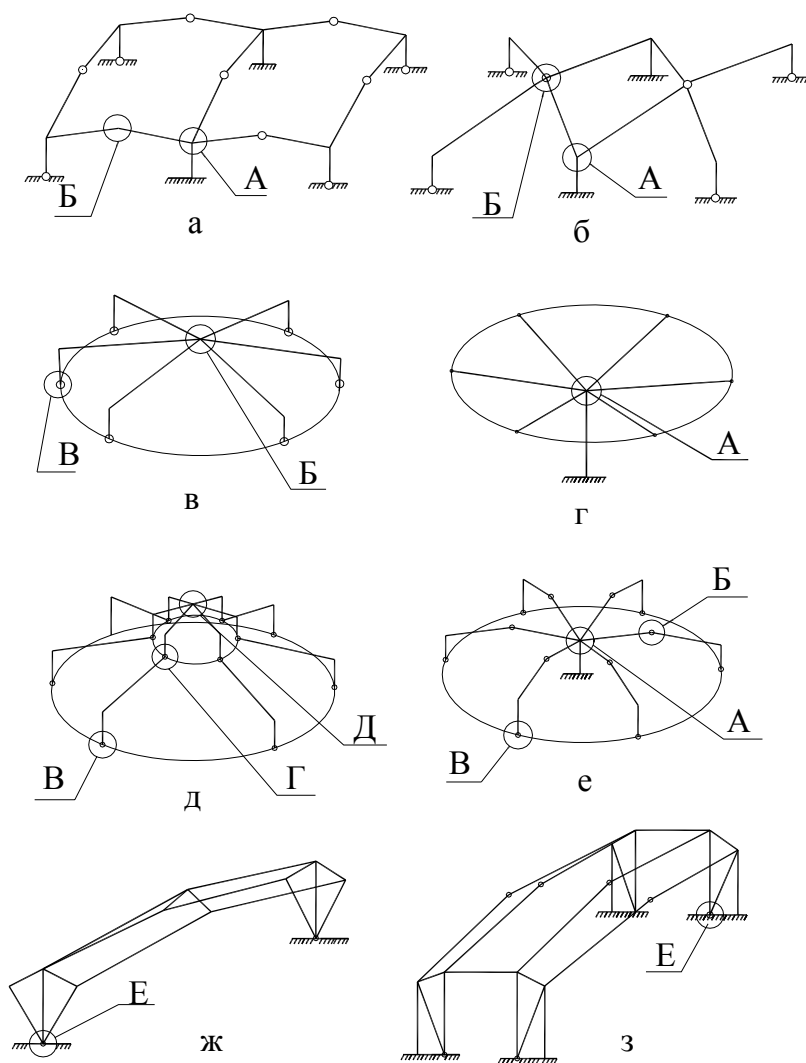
Конструктивні схеми каркасів споруд із тришарнірних залізобетонних рам
